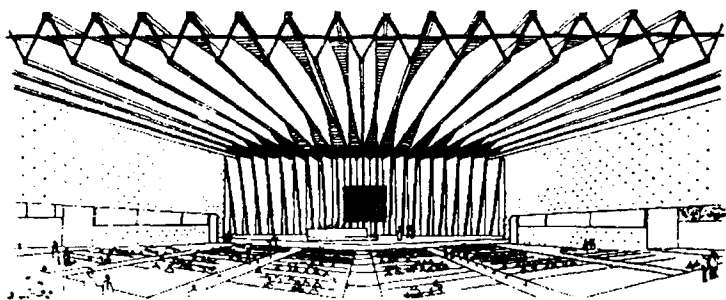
Складчатое покрытие из железобетонных элементов конференц-зала ЮНЕСКО в Париже. Архит. П. Нерви, М. Брейер, Б. Зерфюсе
